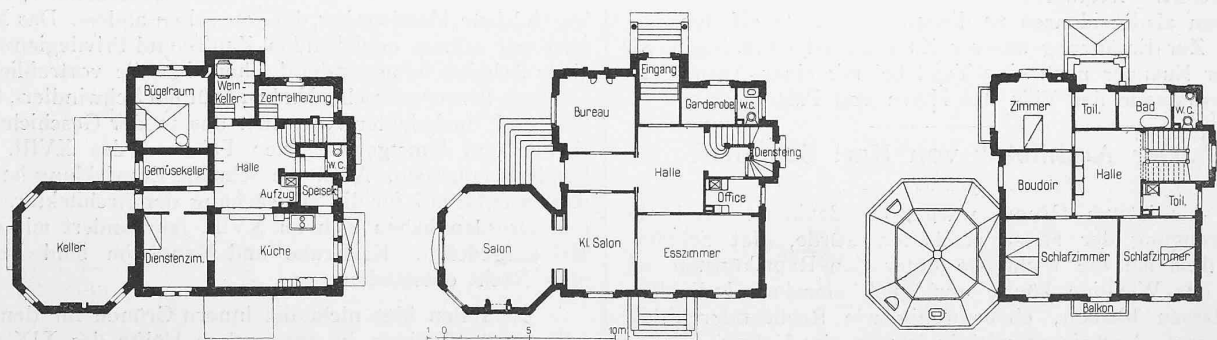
, 13, 14. Grundrisse vom Keller, Erdgeschoss und ersten Stock der italienischen Gesandtschaftsvilla. — 1:400.
